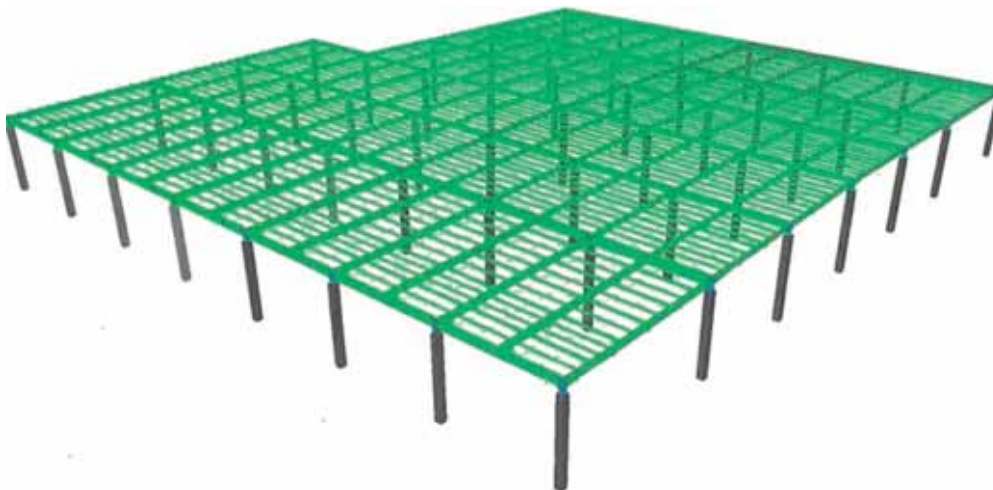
Modelo Estructura Metálica Centro de Distribución TOTTUS en Plataforma TEKLA STRUCTURES.
